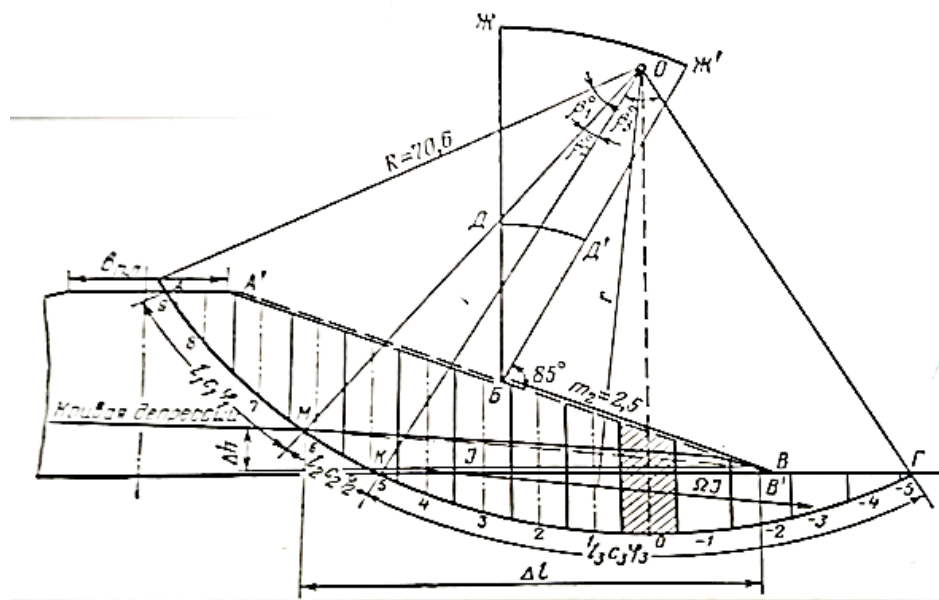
Расчетная схема устойчивости низового откоса земляной плотины
